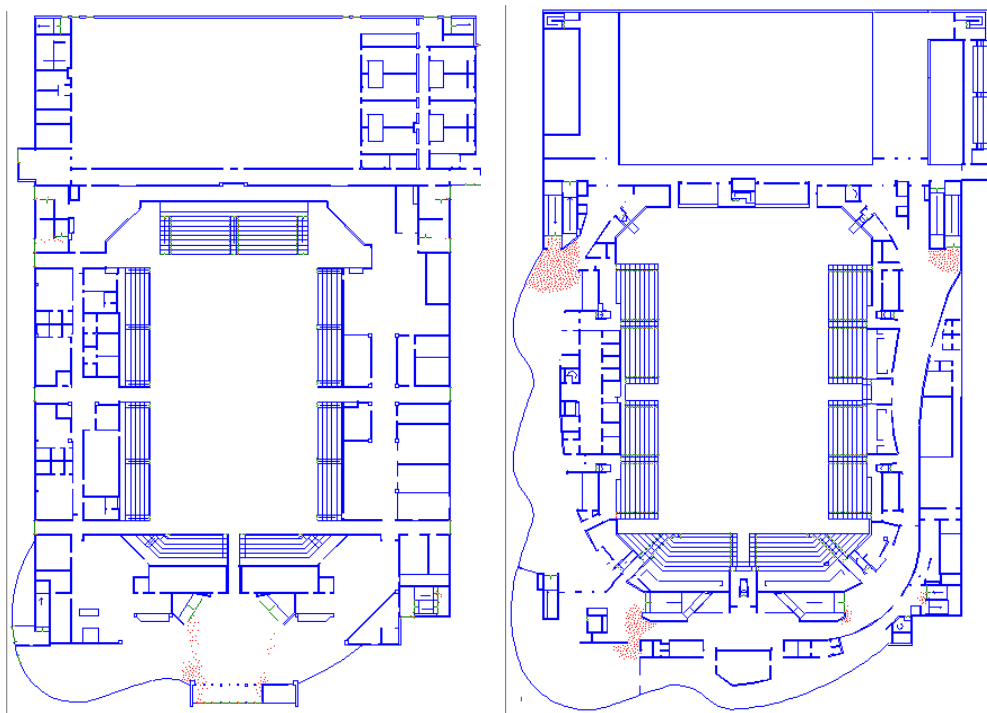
Simuleringens utseende efter 120 sekunder. Till vänster syns plan 1 och till höger plan 2.
